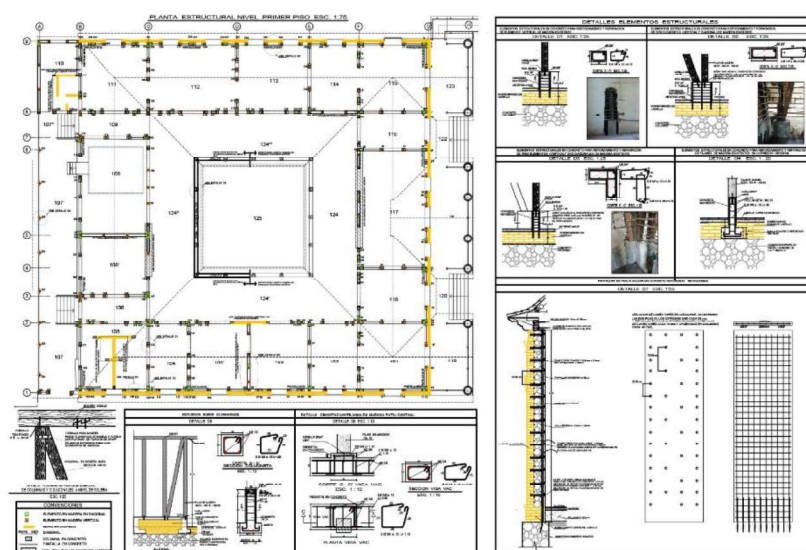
Consolidación estructural – Muros de bahareque y ladrillo – Plano record de las obras-
